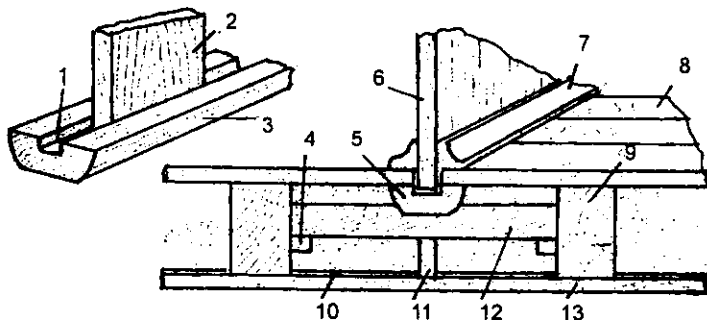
Перегородка располагается между балками и опирается на шпалу
